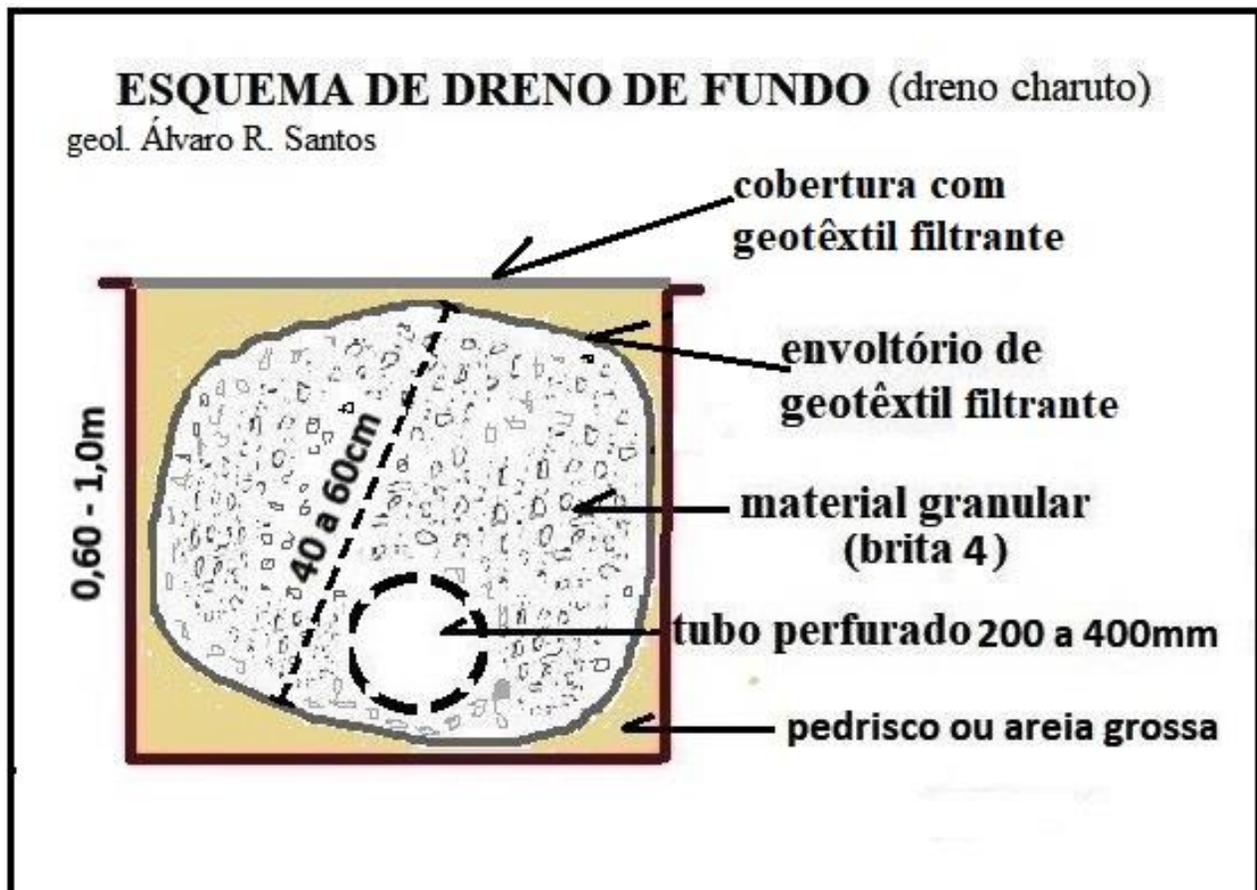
Esquema de dreno a ser adotado no sistema drenante espinha de peixe. Fonte: ARSantos
